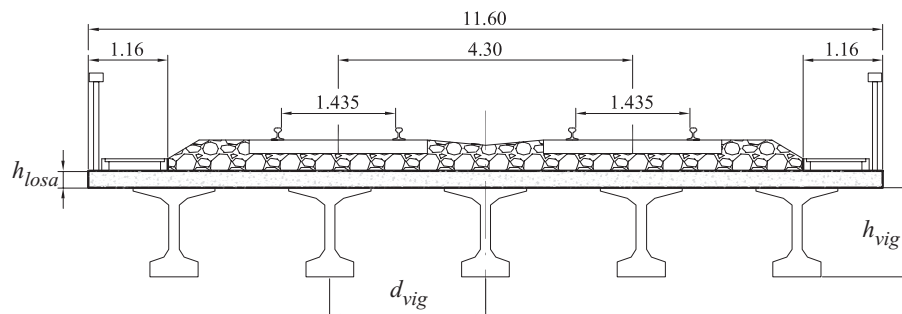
Sección recta transversal de los puentes de vigas de luces comprendidas entre 10 y 25 m. Unidades (m)
